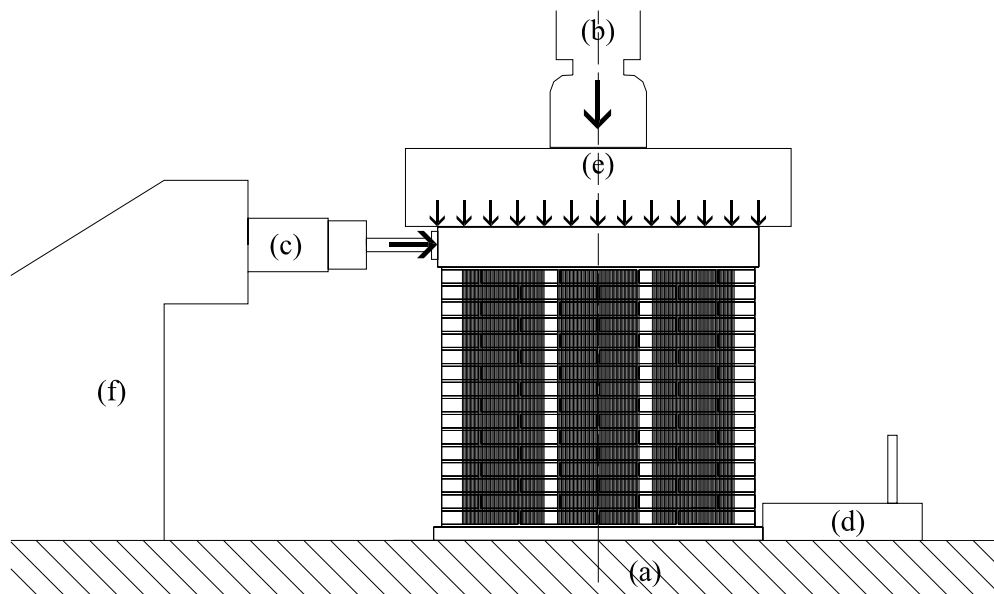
Esquema del montaje de los ensayos de rotura de paneles reforzados con tejido y laminado CFRP.
